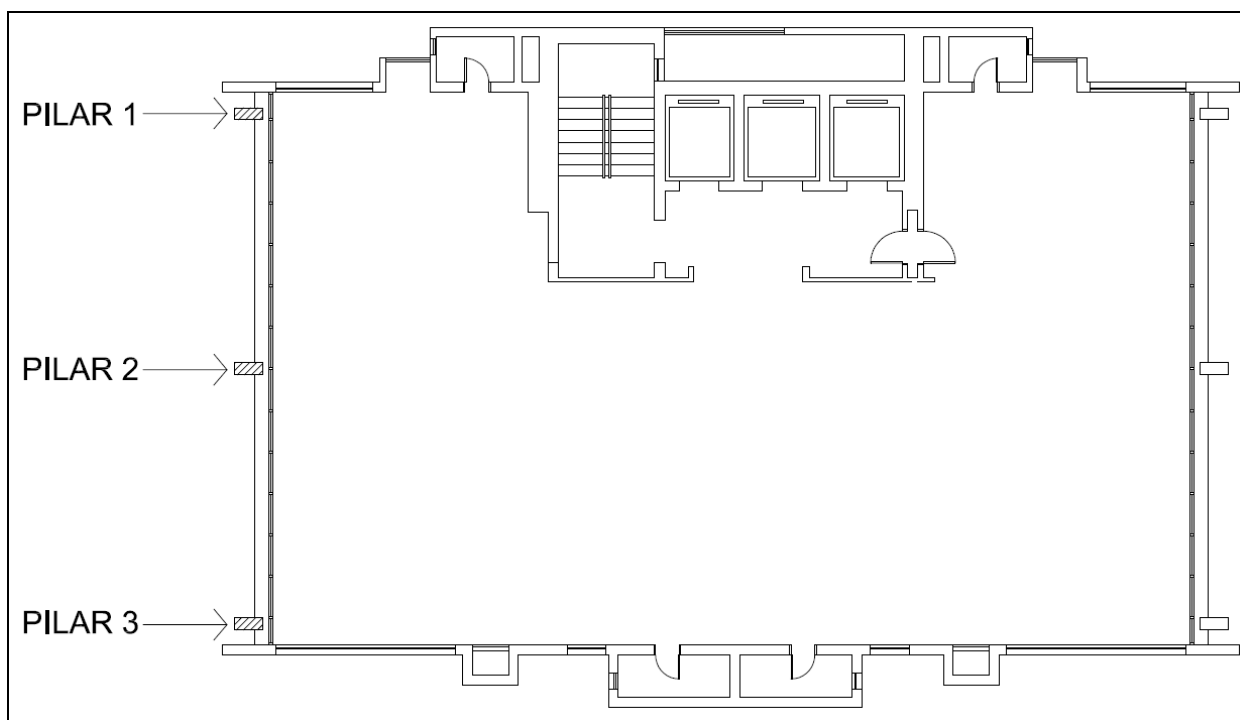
Planta baixa do 5º pavimento com identificação dos pilares vistoriados
